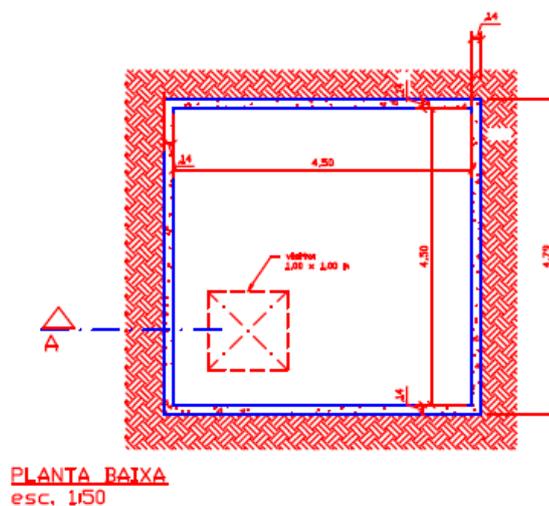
Planta baixa com a intervenção proposta para as obras de adequação para a captação e armazenamento das águas de chuva do prédio do bloco “O”
